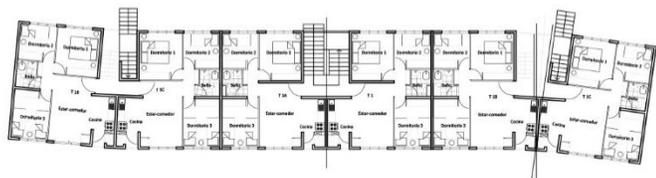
Planta piso tipología 1. Fuente: Elaboración propia
